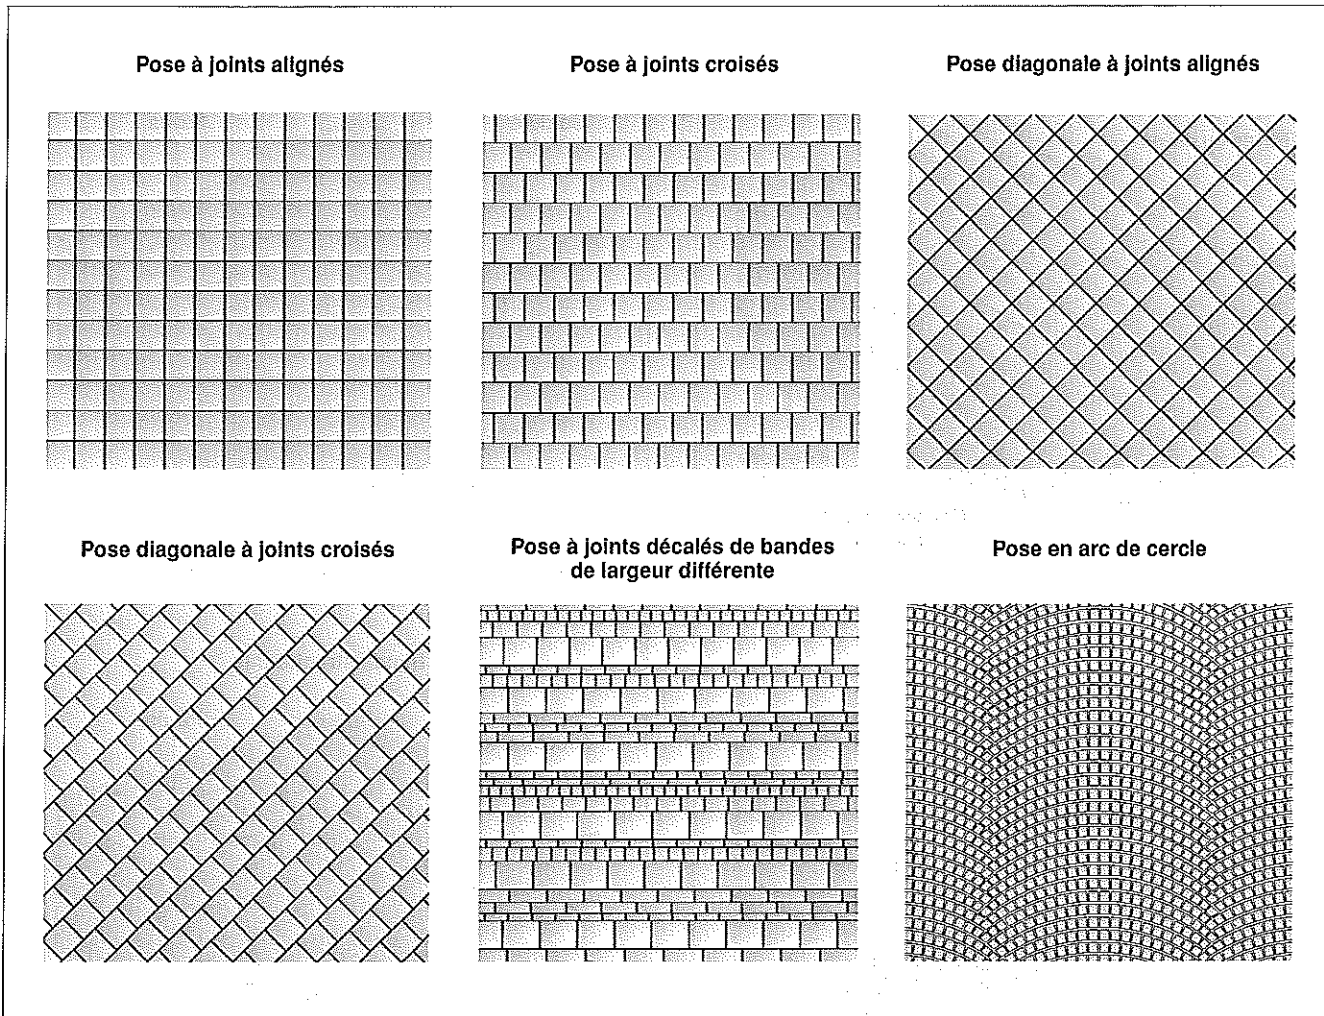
Calepinage de chaussée en pavés.
